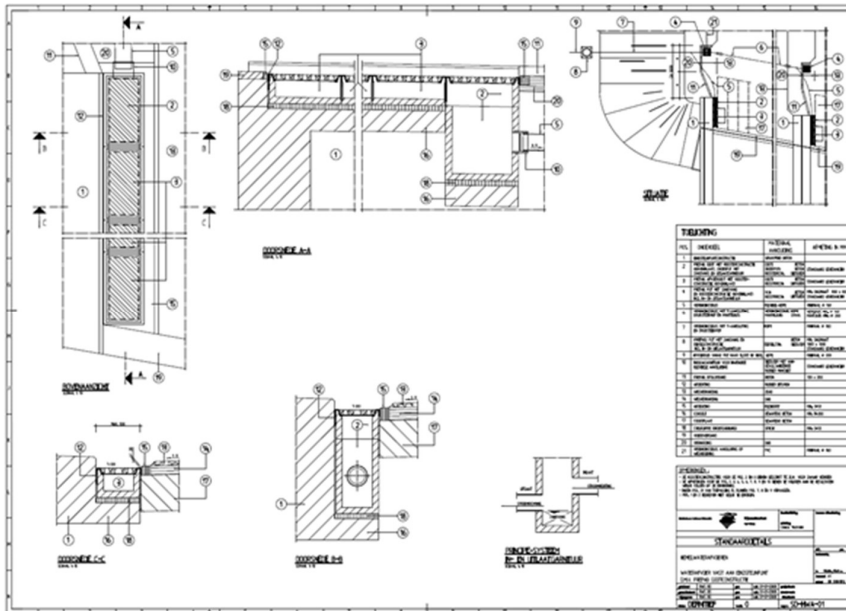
Verlichting tpv van voorzetwand onder kunstwerk [bron: Integraal plan vormgeving]
